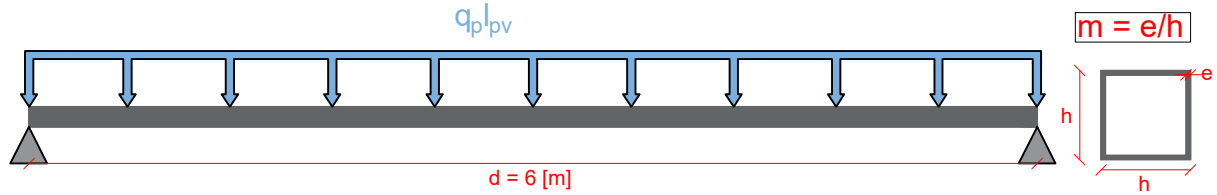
Schéma statique d'un profilé supportant une trame de panneaux solaires.
